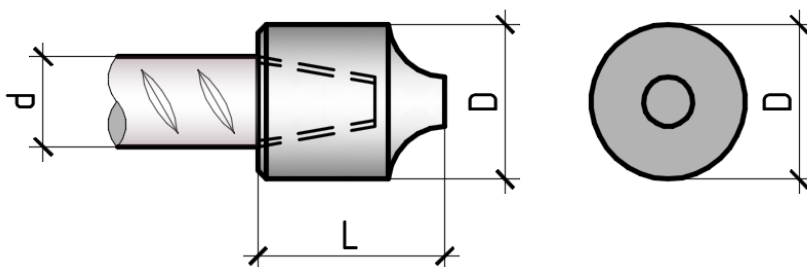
Муфты типа W сварных соединений K2-ARMTECH-C
